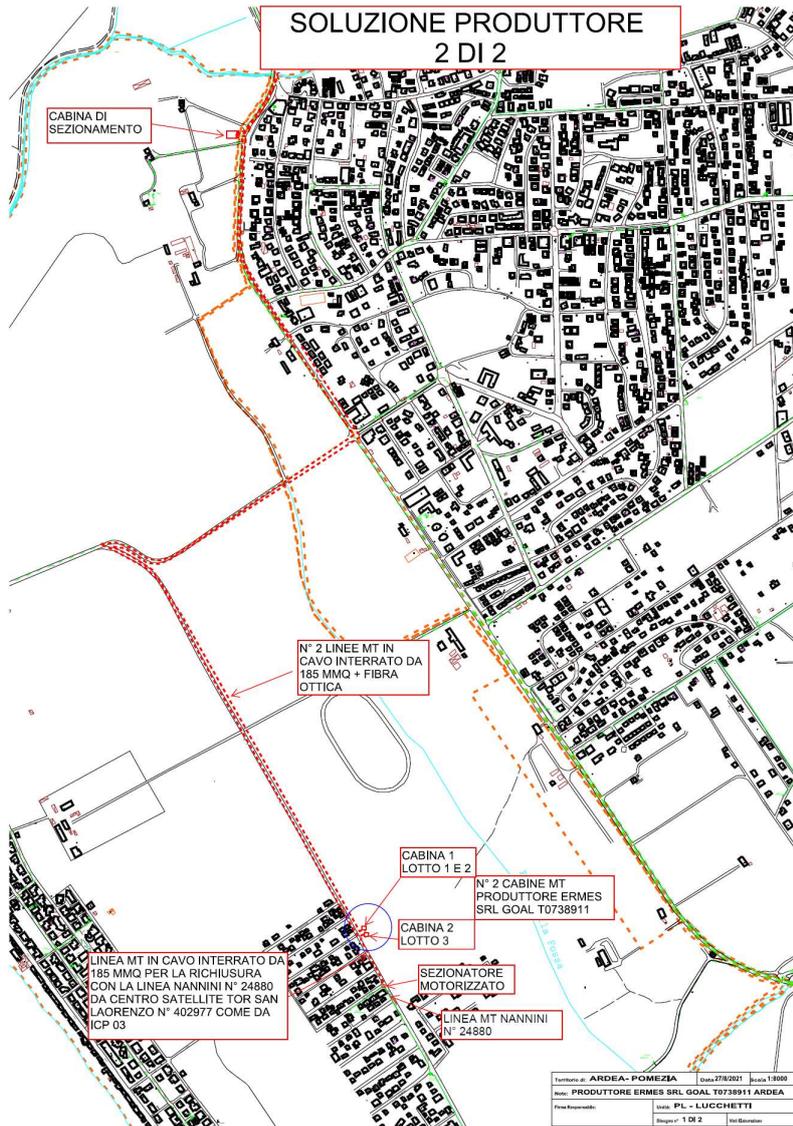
Impianto di rete per la connessione da realizzare con cavo interrato proposto da E-distribuzione
